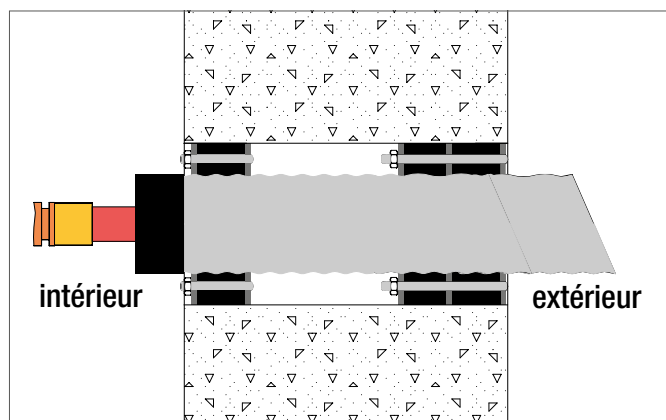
Bride murale étanche FA 40 et FA 80 - vue latérale.
